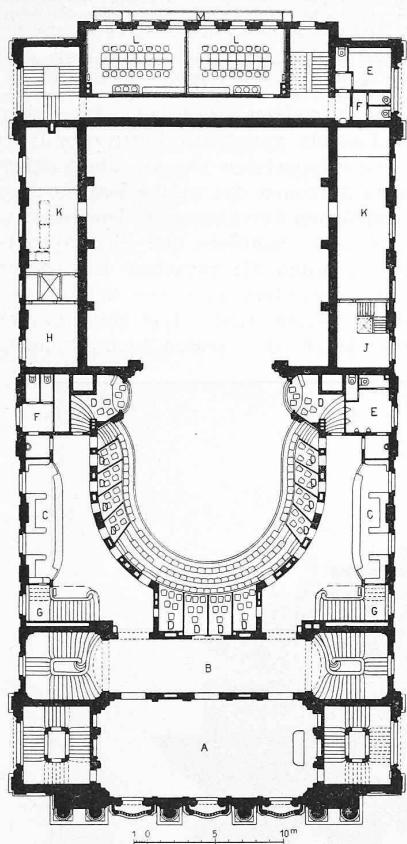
Grundriss vom ersten Untergeschoß. 1:500.
